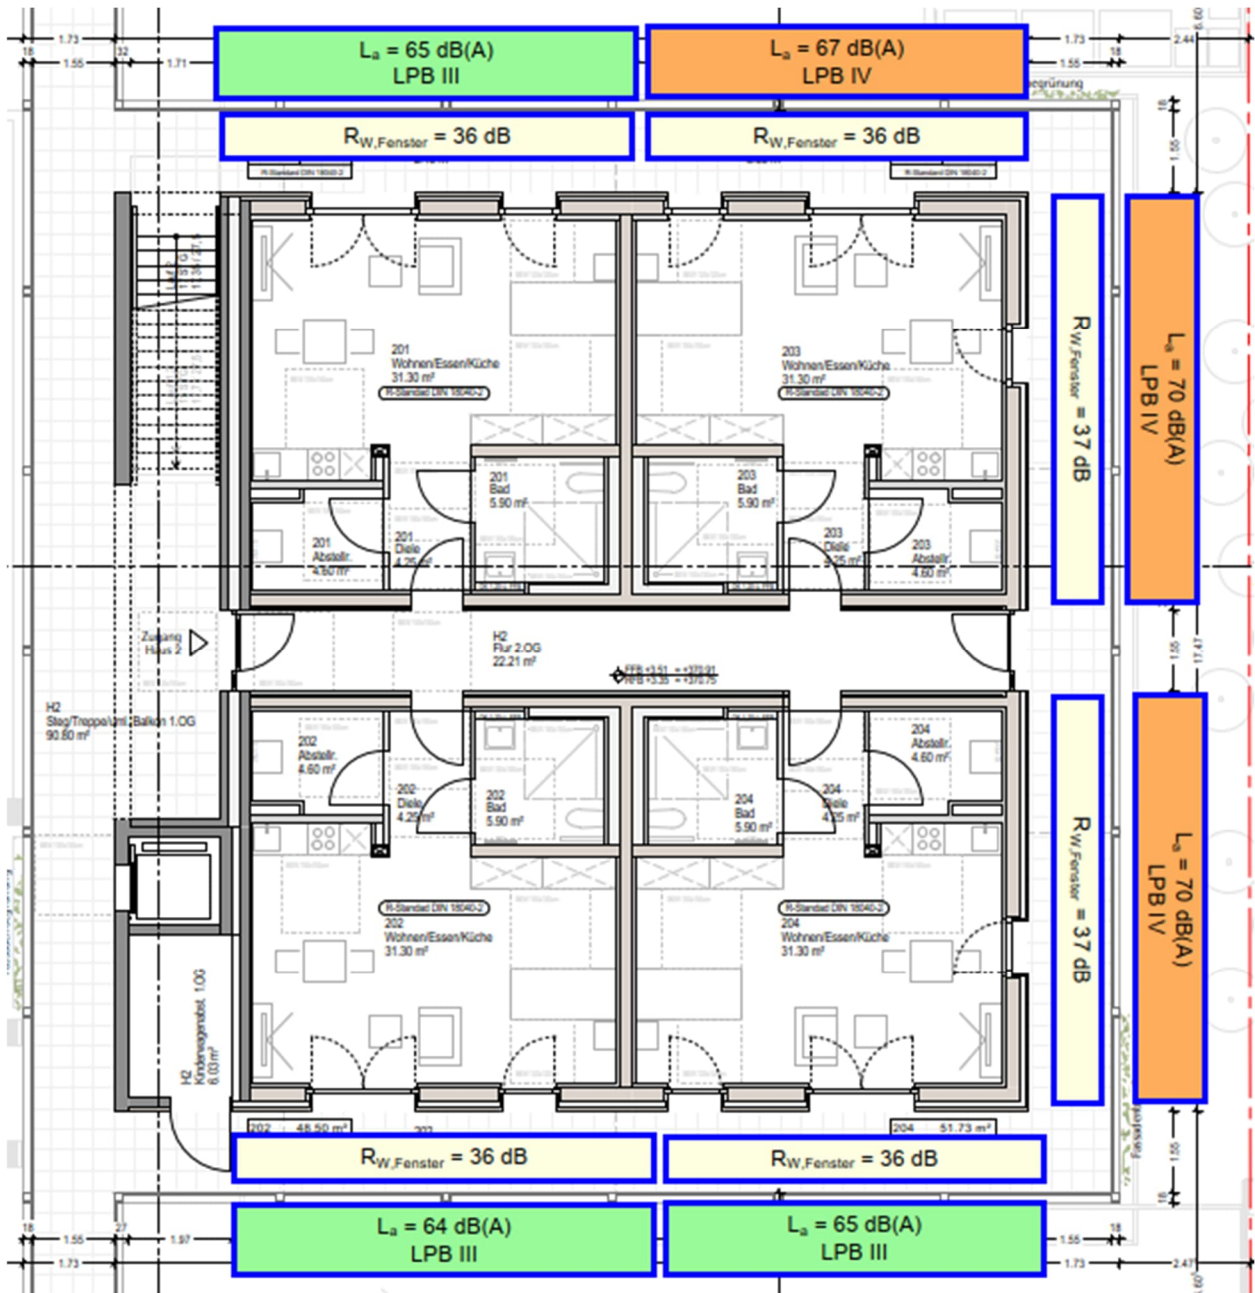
Außenlärm – Grundriss 1.OG – Haus 2
